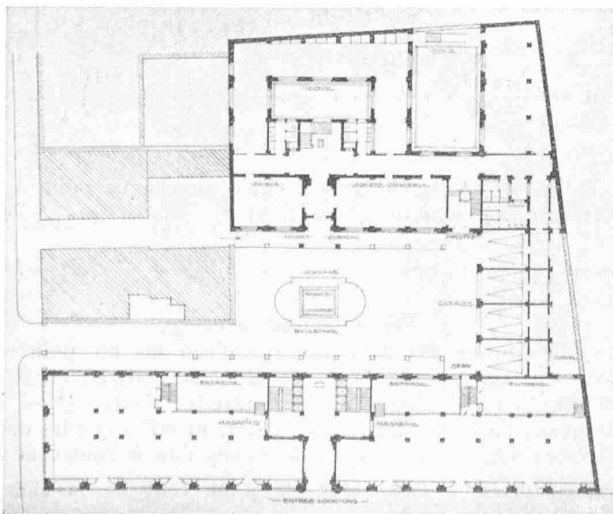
Erdgeschoss im ersten Ausbau. — 1:800.
